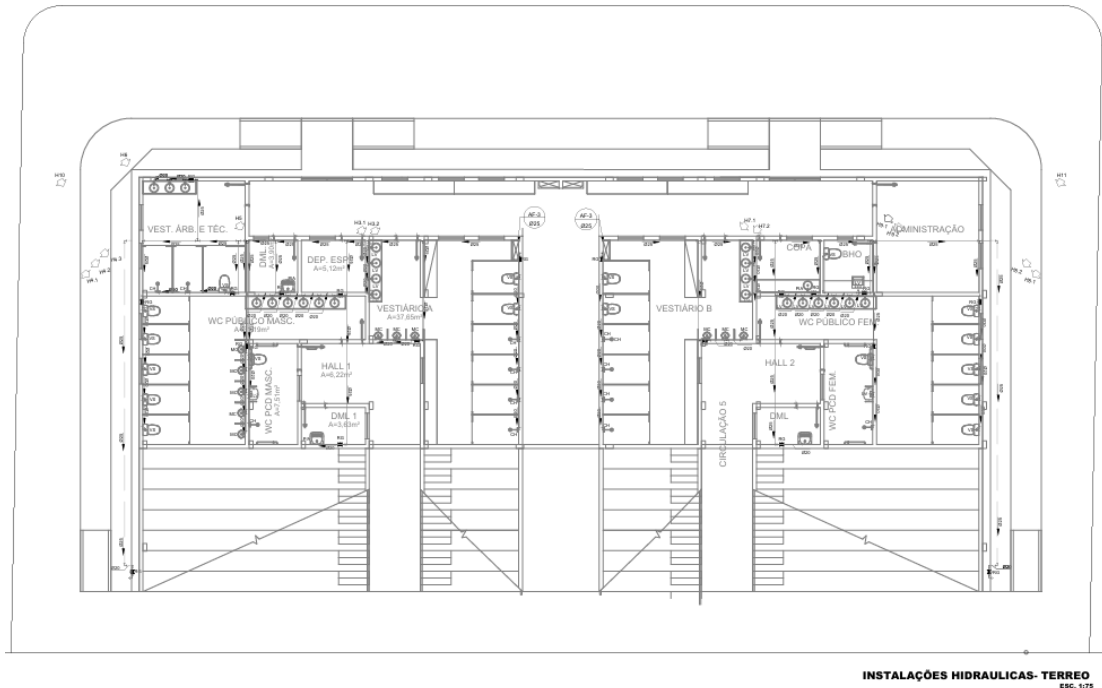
Instalações Hidráulicas do Pavimento Térreo
